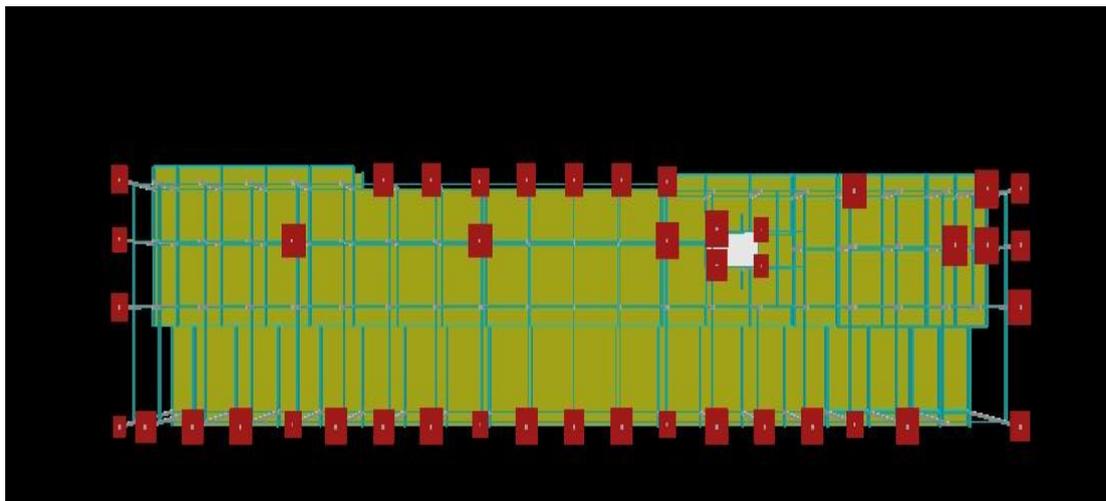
Projeto estrutural com fundação utilizando solo 1.
